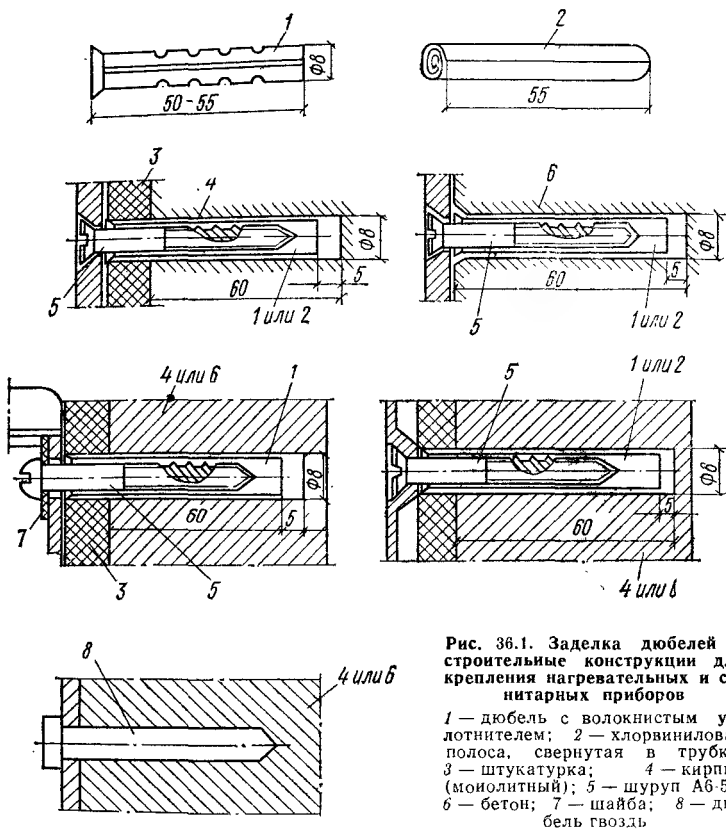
Заделка дюбелей в строительные конструкции для крепления нагревательных и санитарных приборов
